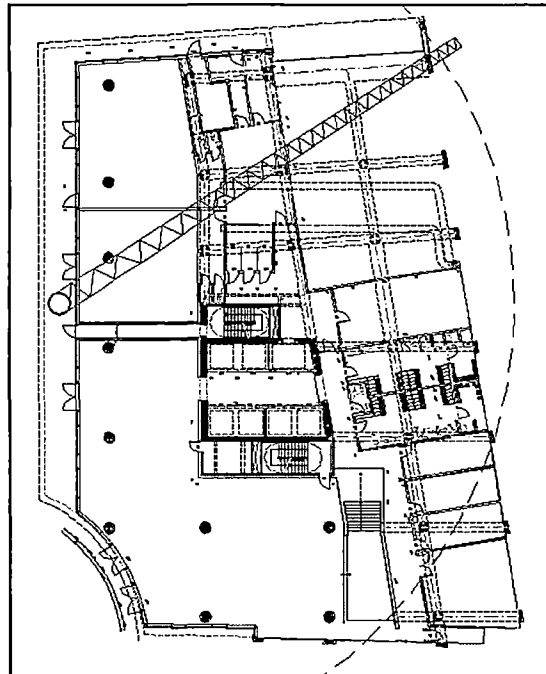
Layout de planta-Alcance de grúa torre. Obra: Real 8
